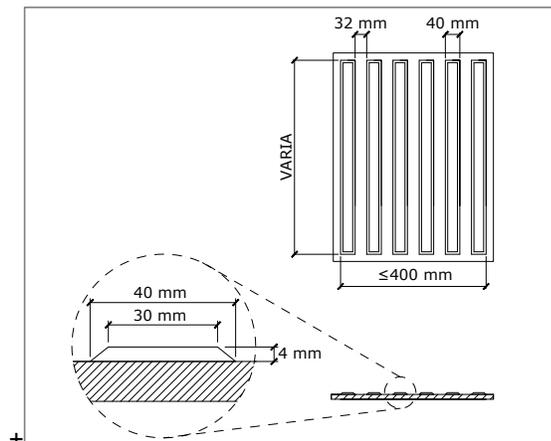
Ejemplo de pavimento táctil en aproximación a edificación
